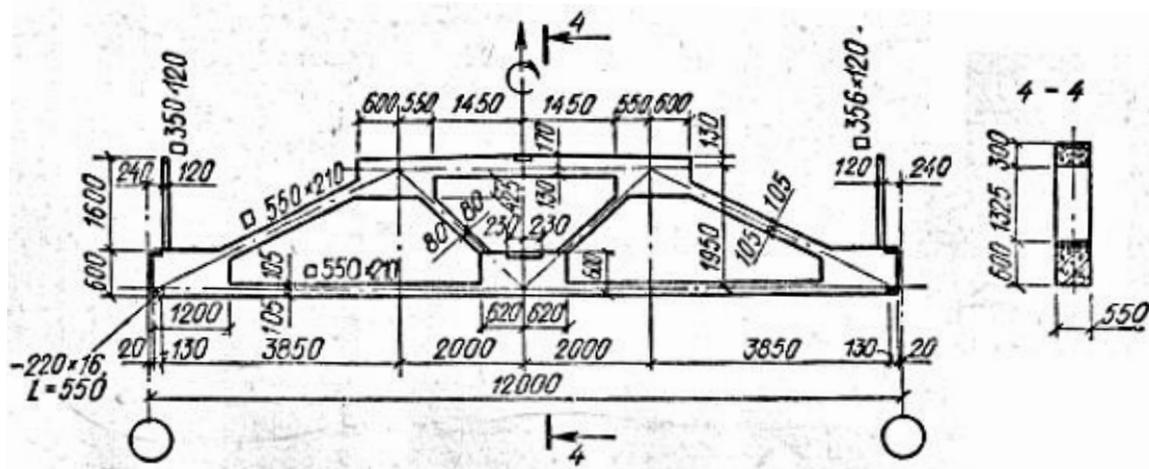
Железобетонная стропильная решетчатая балка
